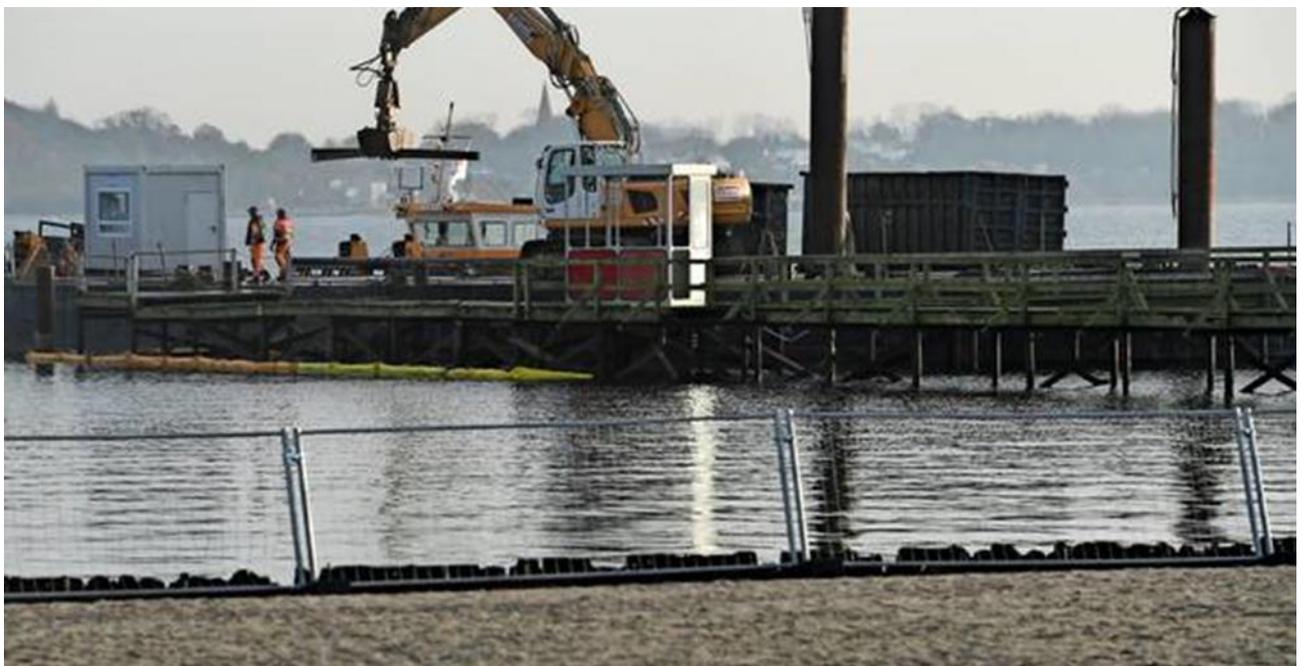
Rückbau der Steganlage im November 2017 (stralsund.de)
